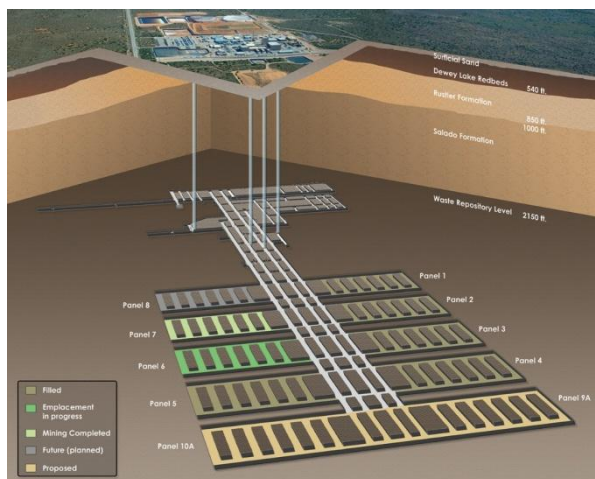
Сховище Waste Isolation Pilot Plant (США)
